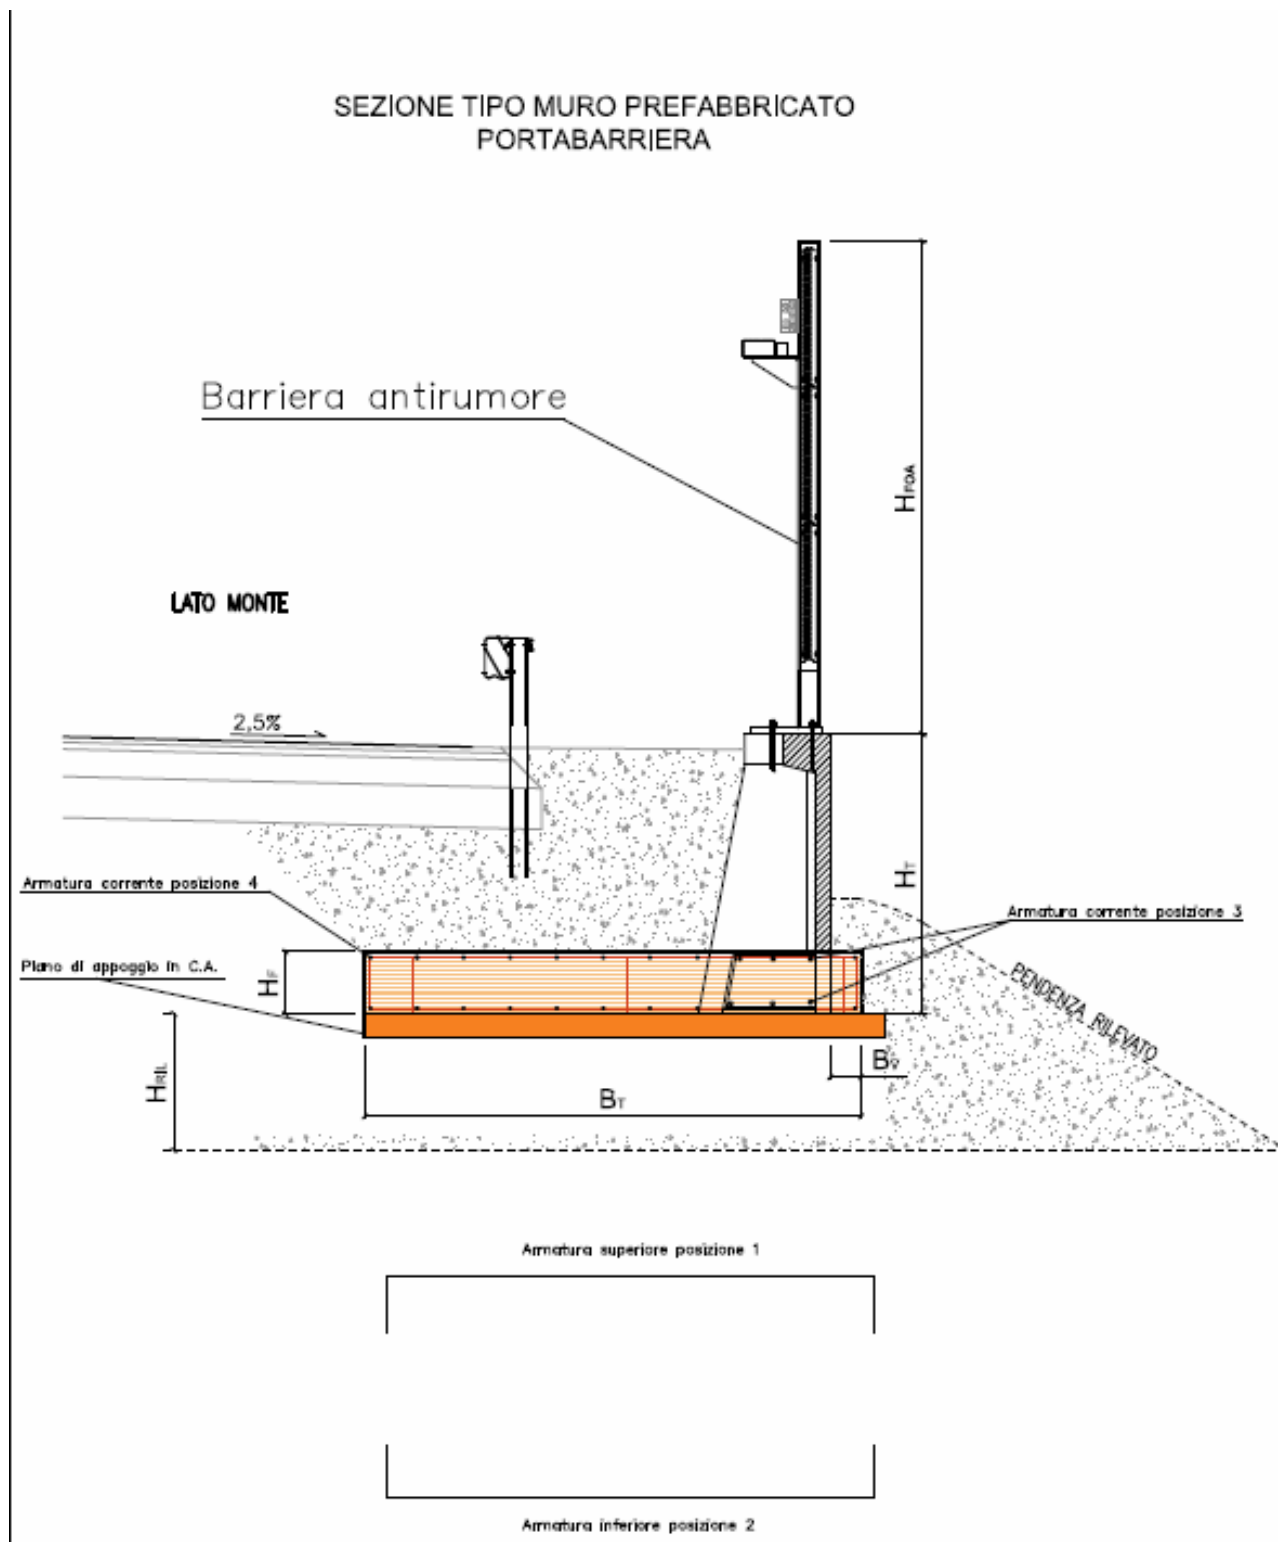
Sezione tipo del muro prefabbricato per barriera fonica semplice su fondazione diretta
